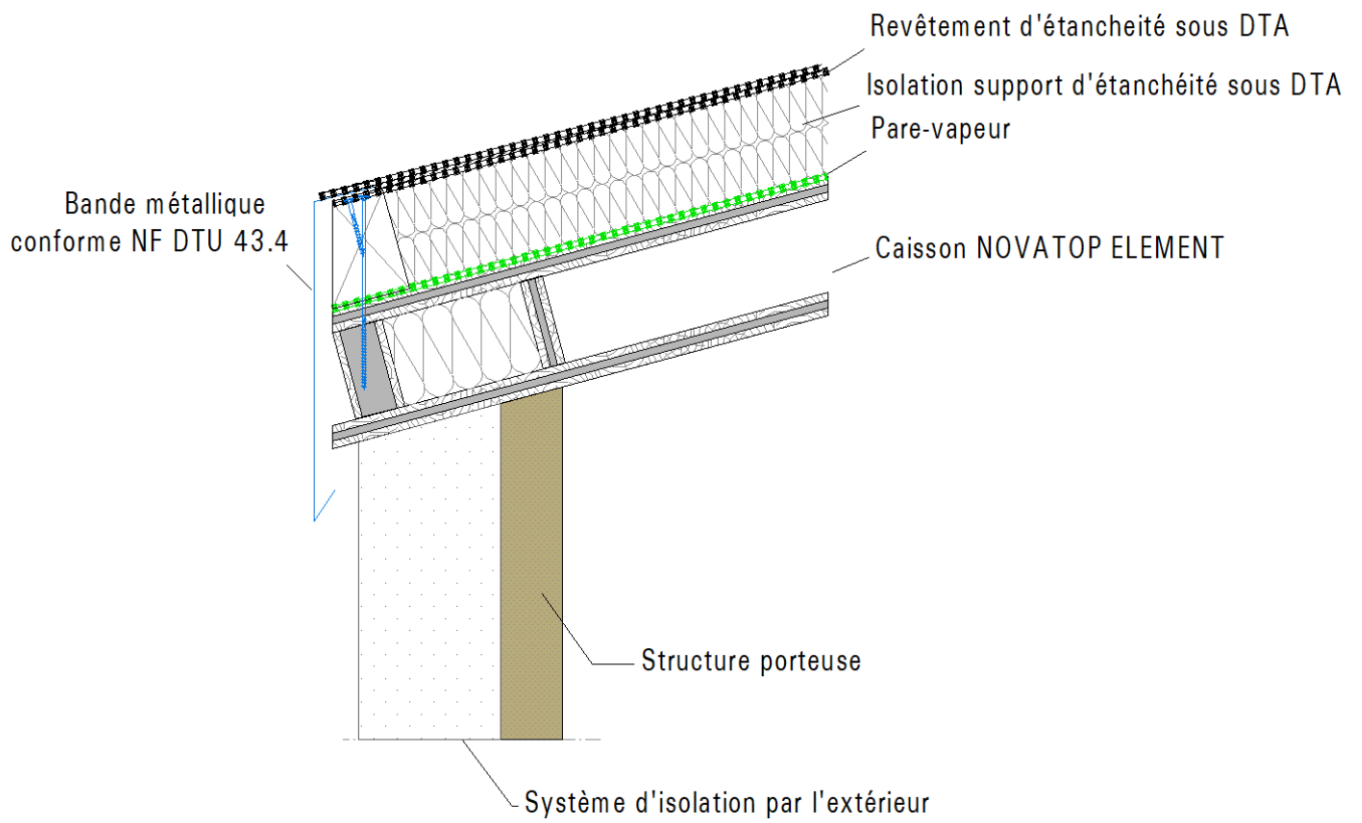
A1 – Rive de revêtement d'étanchéité autoprotégé bicouche
